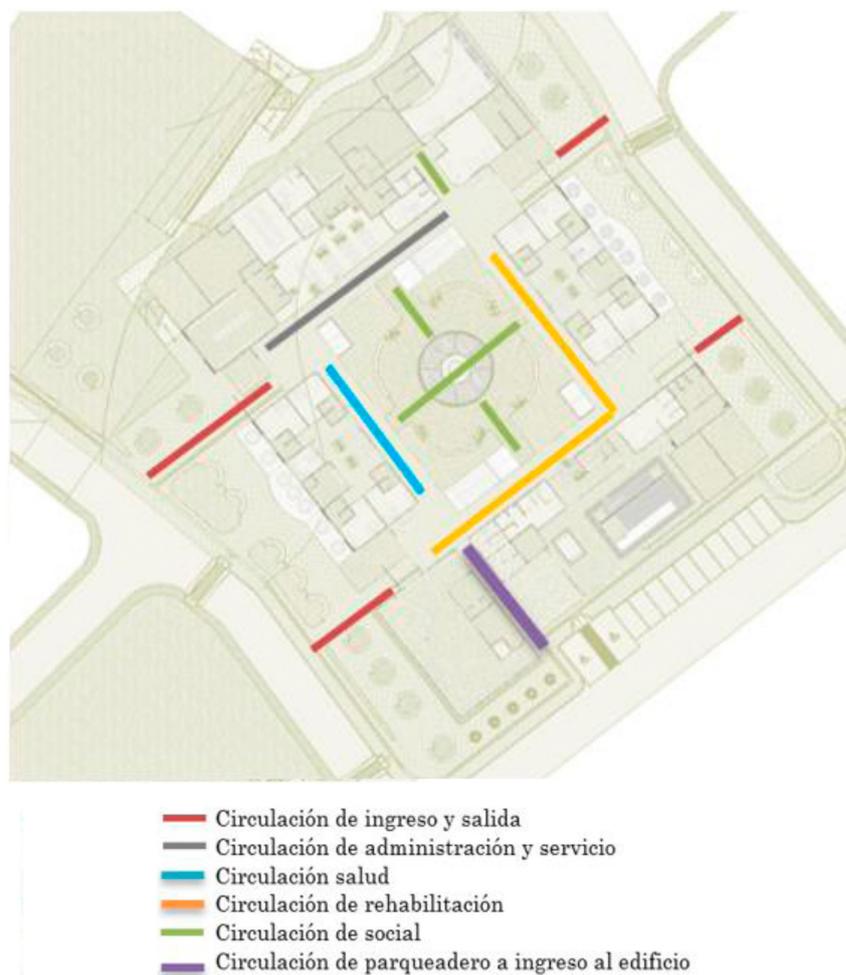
Diagrama circulación planta baja. Fuente y Elaboración: Autor.
